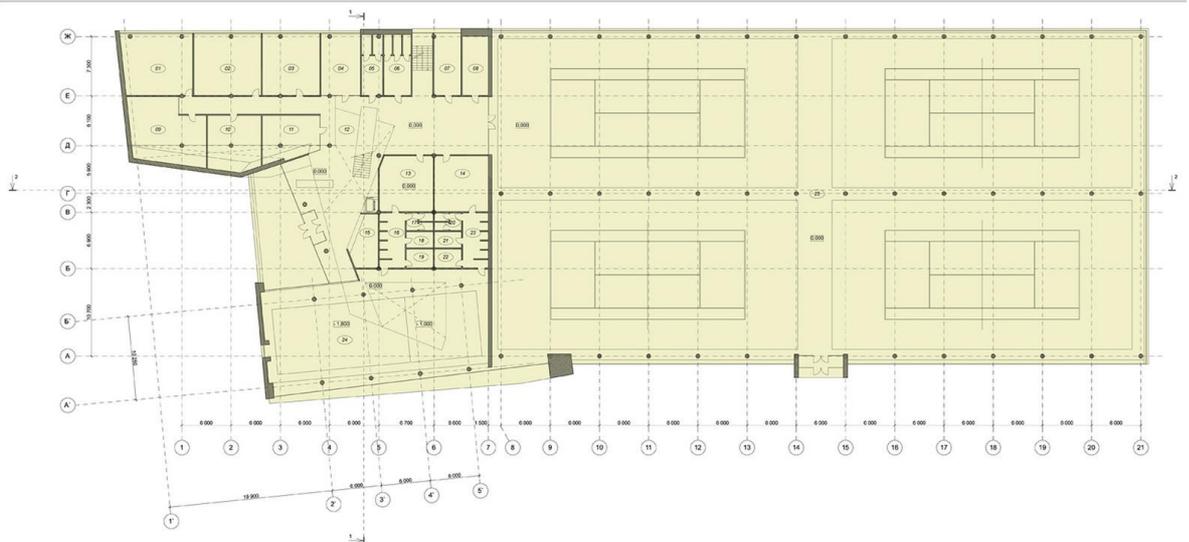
Plantas y Vista Exterior Cancha de Tennis Istra
